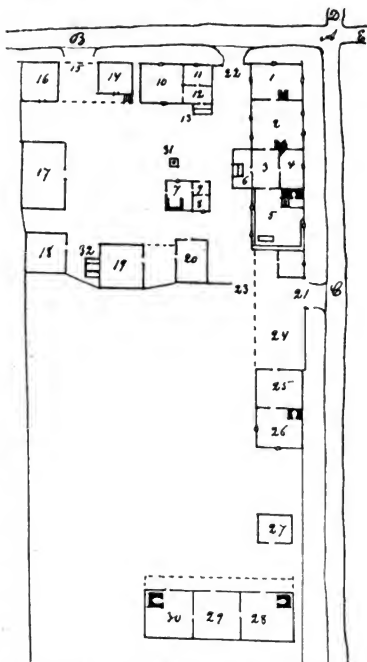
Grundriss eines tawastländischen Bauerhofes. Renko. Tawastehus.
